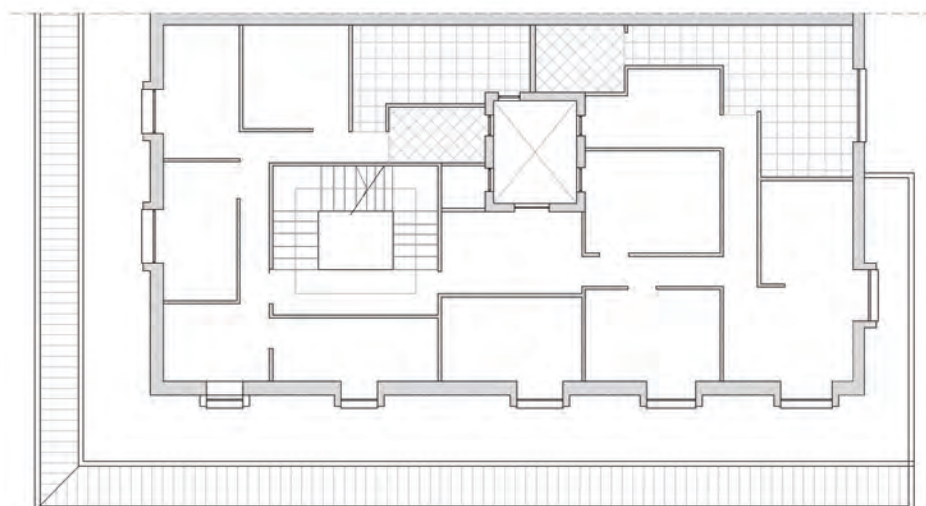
15. TERCERA PLANTA, PLANTA BAJOCUBIERTA
